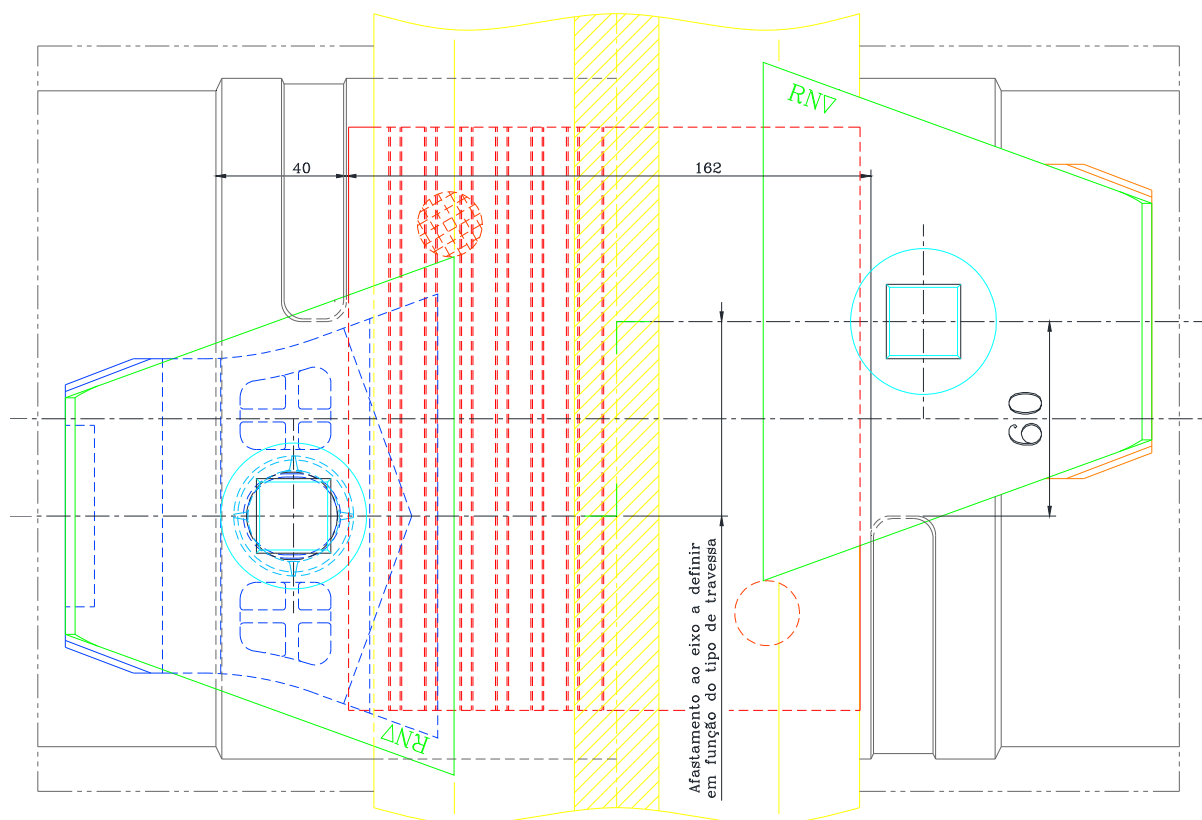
Posicionamento das fixações em travessas VAX LU 41 NG
